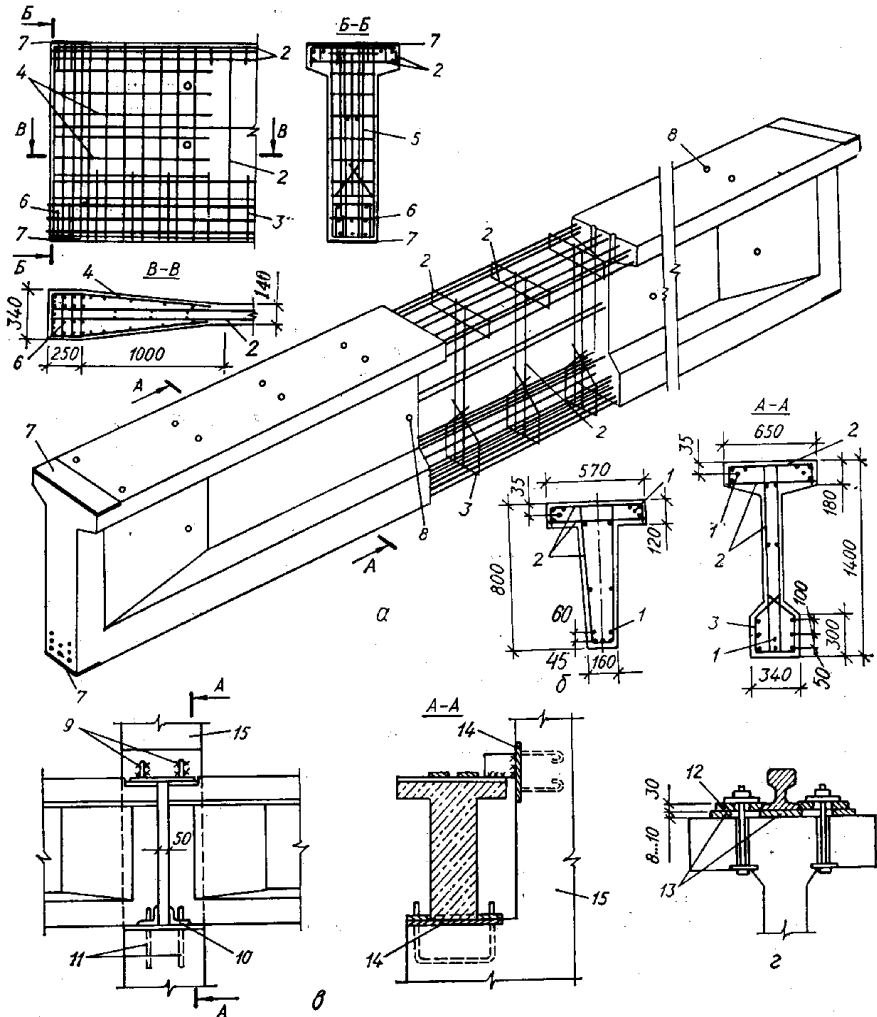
Підкранові балки: *а* – прольотом 12 м; *б* – поперечний переріз балки прольотом 6 м; *в* – кріплення підкранової балки до колони; *г* – кріплення рейки до підкранової балки; 1 – попередньо напружувана арматура; 2 – зварні каркаси; 3 – хомути; 4 – гнуті сітки на опорах; 5 – плоскі сітки; 6 – плоскі сітки на опорах; 7 – закладні деталі; 8 – отвори для кріплення підкранових шляхів; 9 – металеві планки; 10 – закладна деталь підкранової балки; 11 – анкери-випуски з колони; 12 – лапки-притискачі; 13 – пружні прокладки; 14 – закладна деталь колони; 15 – колона
